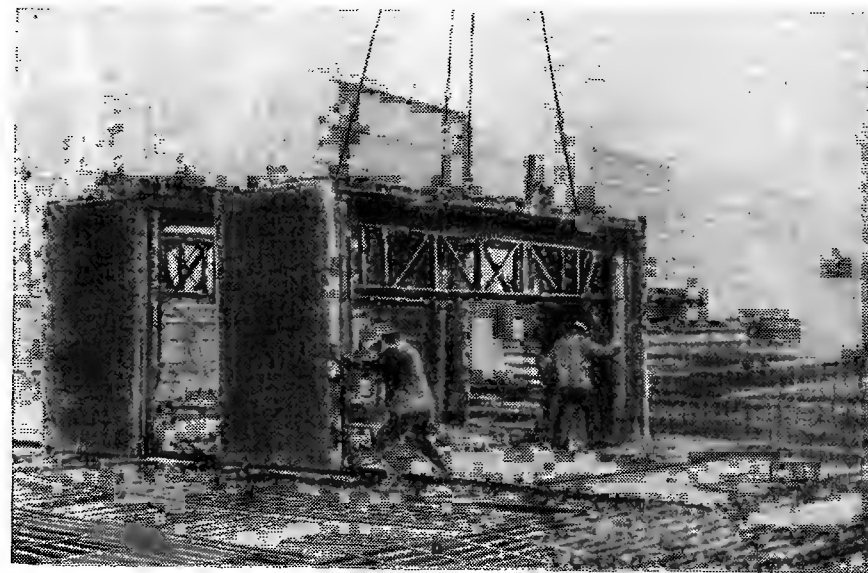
Монтаж секций опалубки на рельсовых путях
